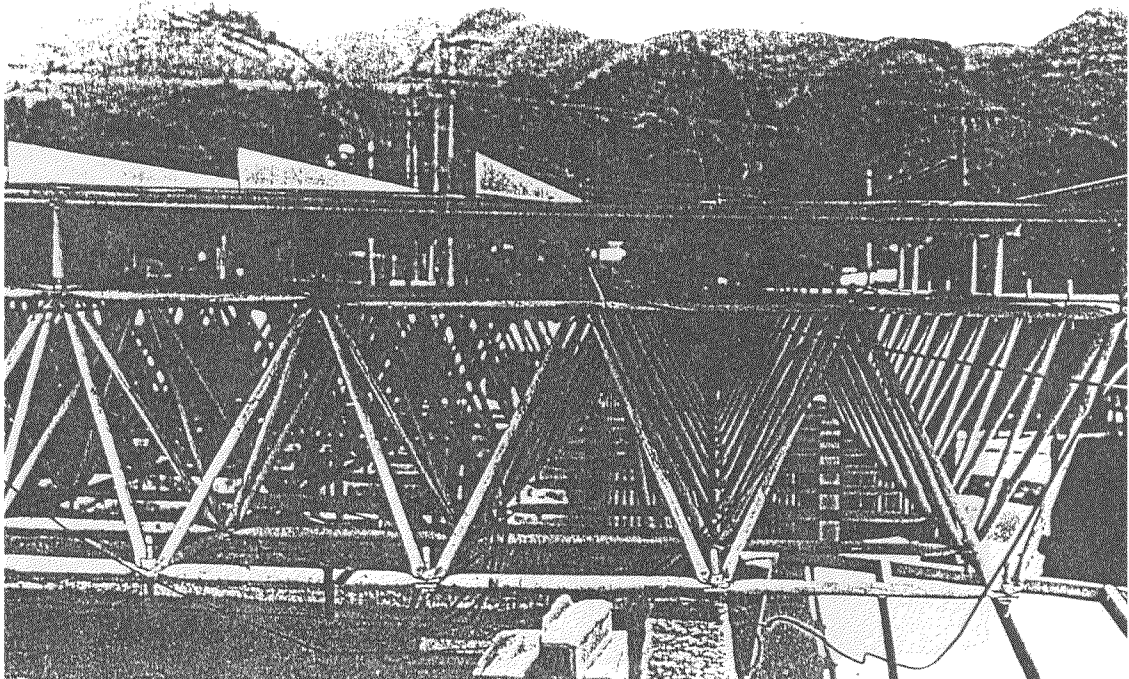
DETALLE DE LA CUBIERTA DE LA ENTRADA DE EMERGENCIA
